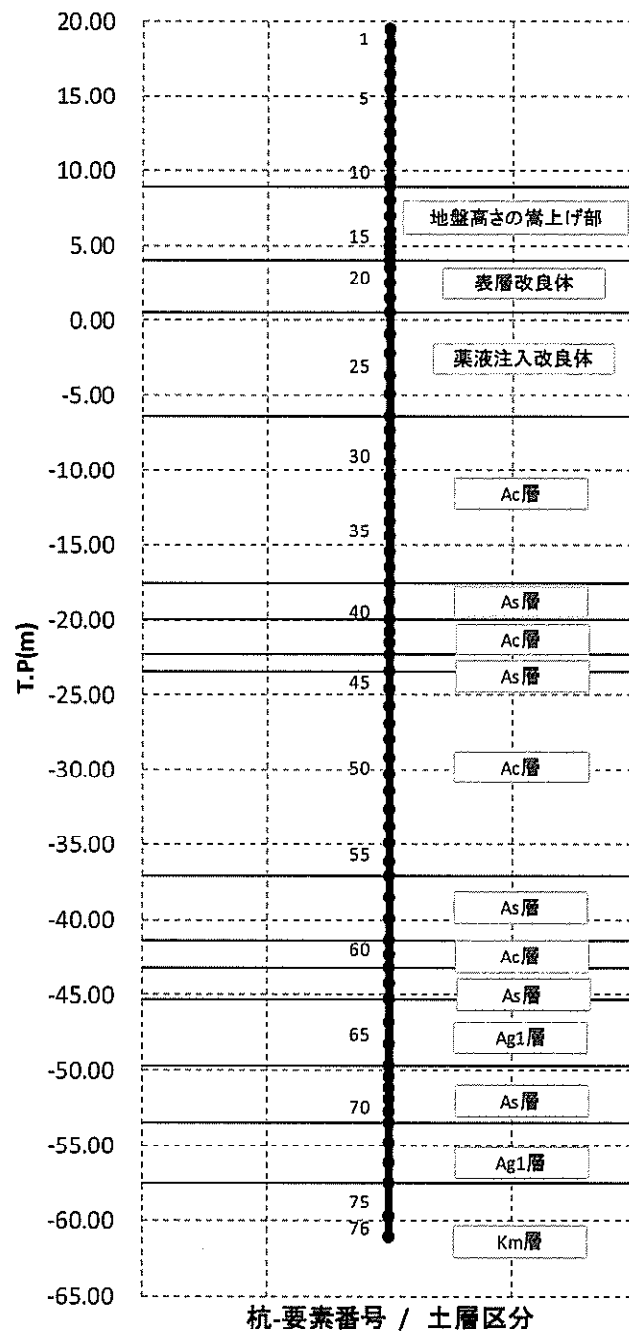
杭要素番号（鋼管杭鉄筋コンクリート防潮壁）
